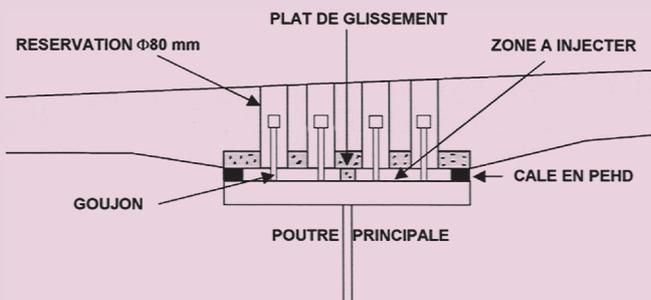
Dispositions prévues dans la dalle au droit des poutres en cas de connexion différée
